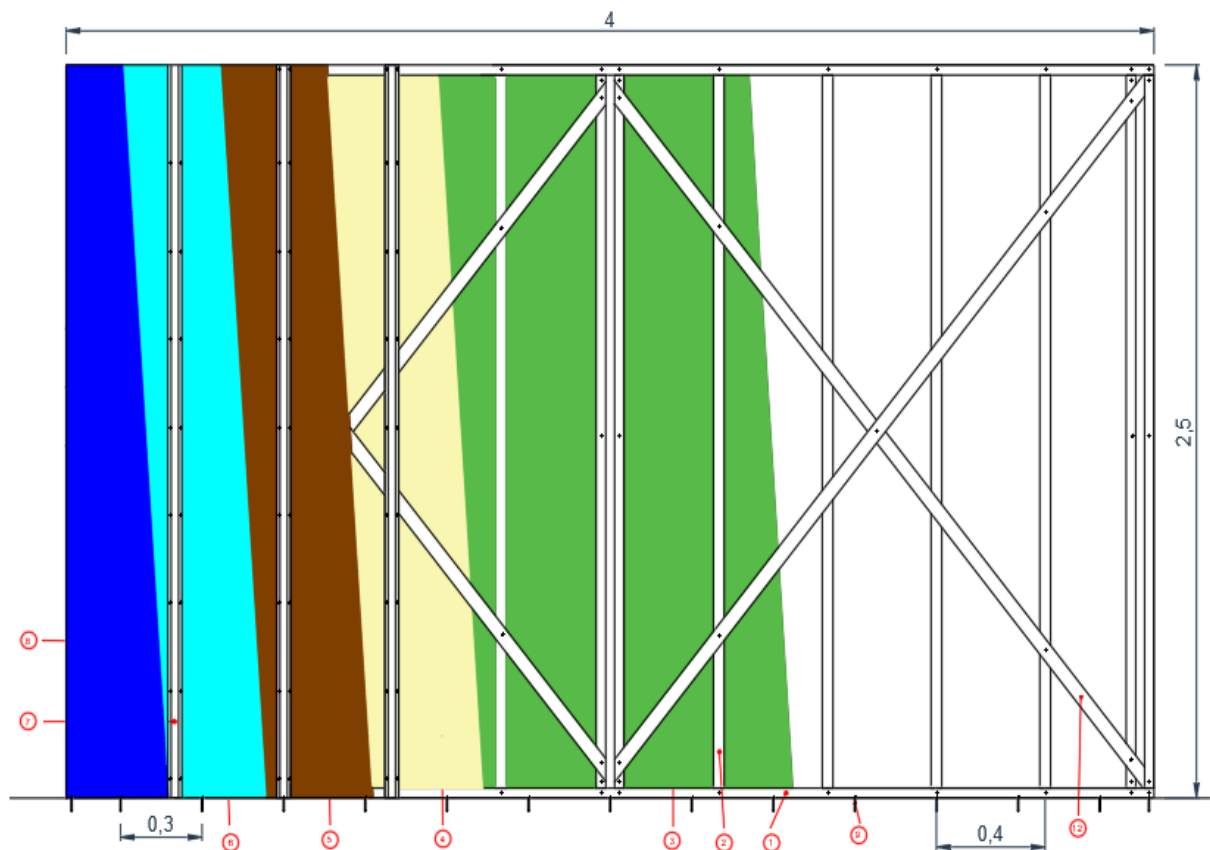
Vista del muro Tipo B, de construcción en Steel Framing.
